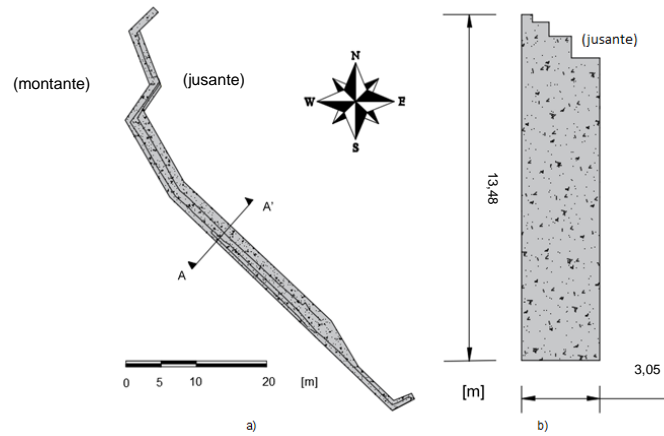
Barragem do Monte Branco: a) vista de topo do coroamento e b) secção transversal.
